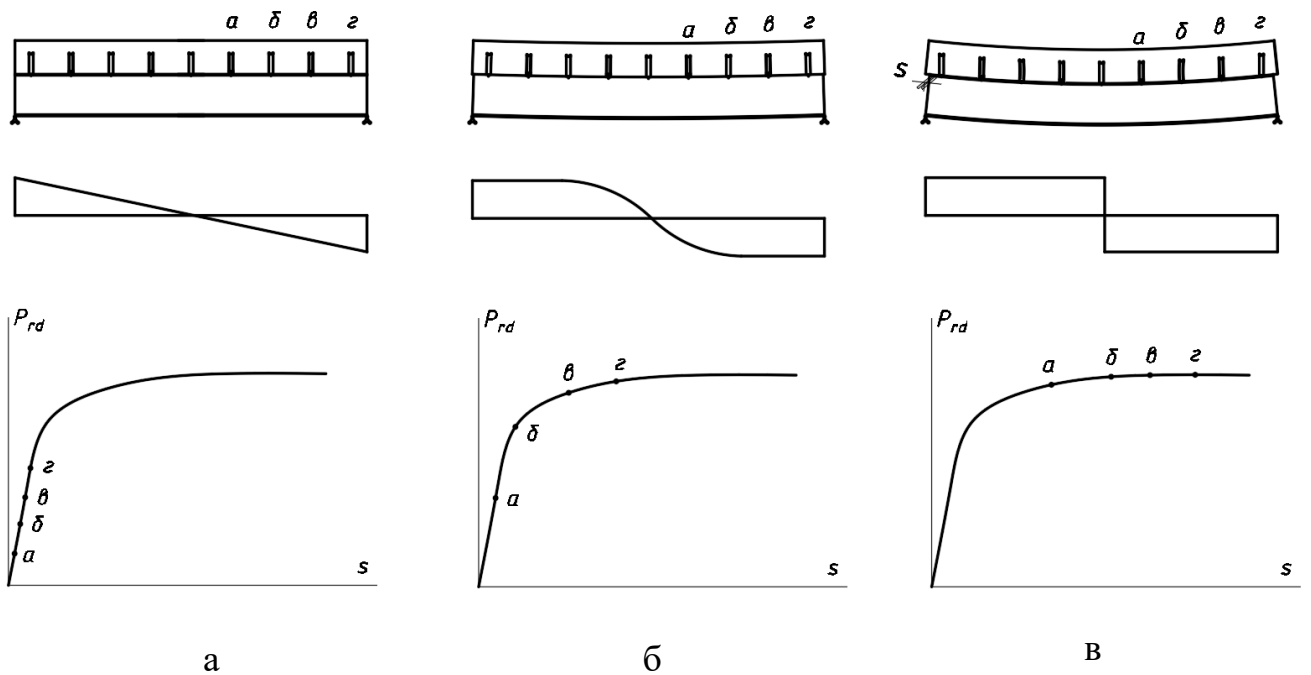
Стадии напряженно-деформируемого состояния сталежелезобетонного перекрытия, объединенного гибкими упорами
